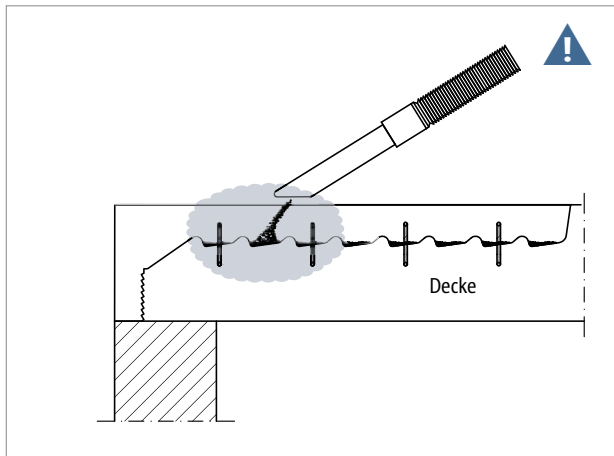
Schöck IDock®: Gründliche Reinigung der Deckenaussparungen mit einem Staubsauger
